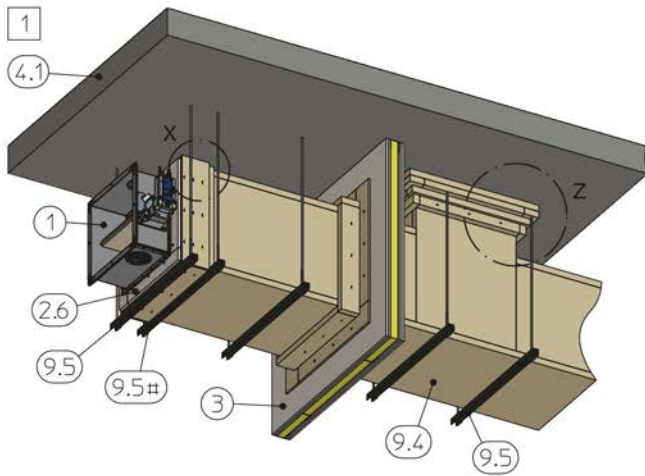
Trockeneinbau auf einer Massivdecke mit Einbausatz WA
